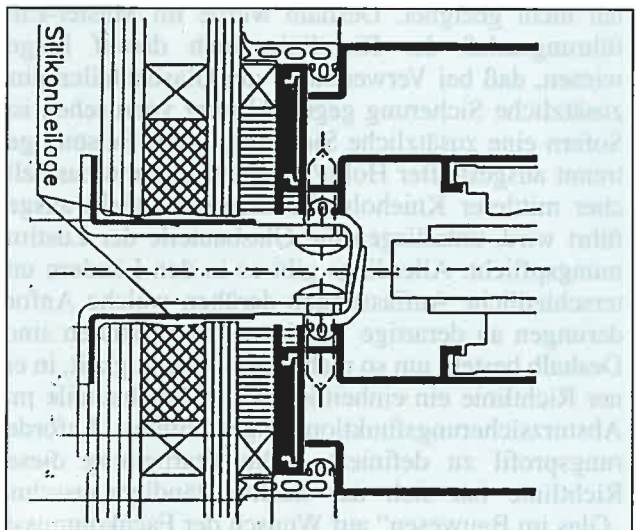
Structural-Glazing-System (WICONA Bauelemente GmbH) mit Eckhaltern als mechanischer Sicherung
